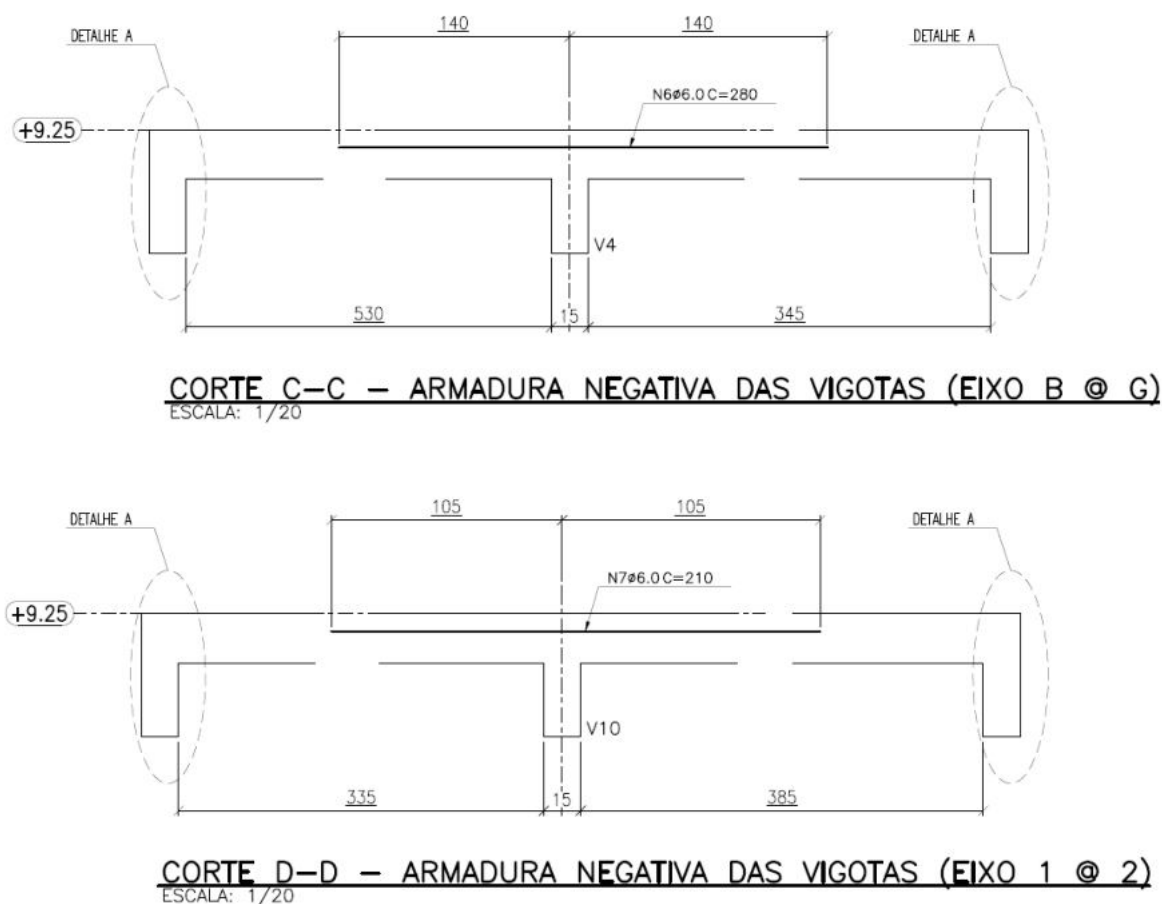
Detalhe Típico - Armadura Negativa (76 e N7 a serem instalados na capa da laje pré moldada ao longo dos apoios (vigas) dos panos de das lajes espaçadas, conforme indicado em projeto
